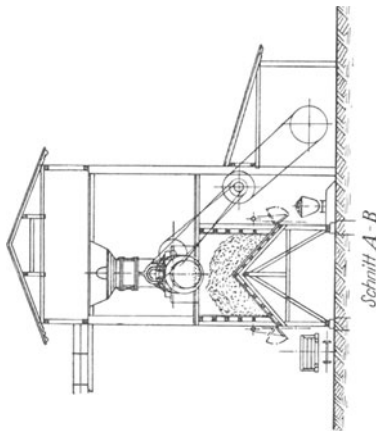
Maschinelles Schotterwerk nach Entwurf der Maschinenbauanstalt Humboldt.
